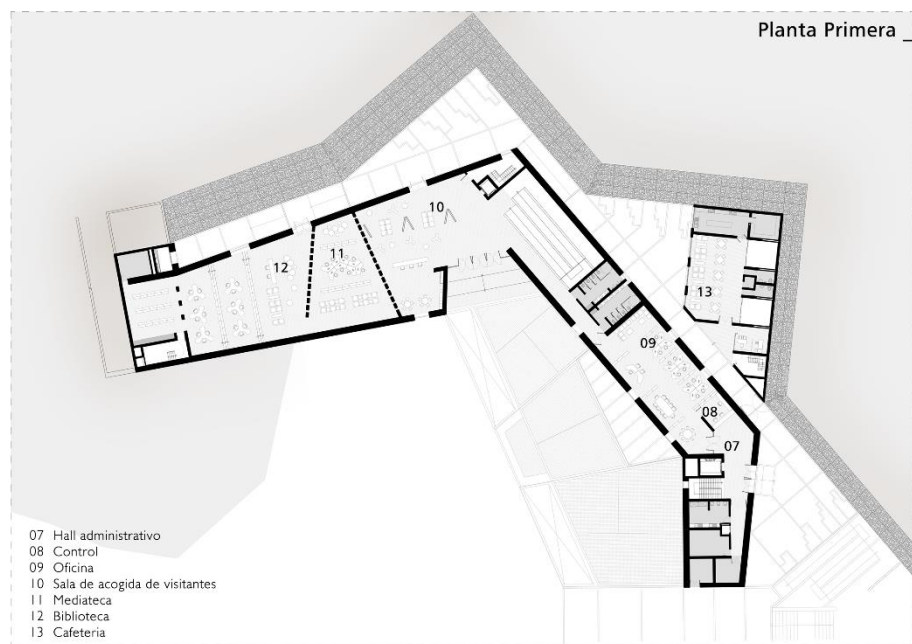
/ planta primera. Fuente: Elaboración propia.
